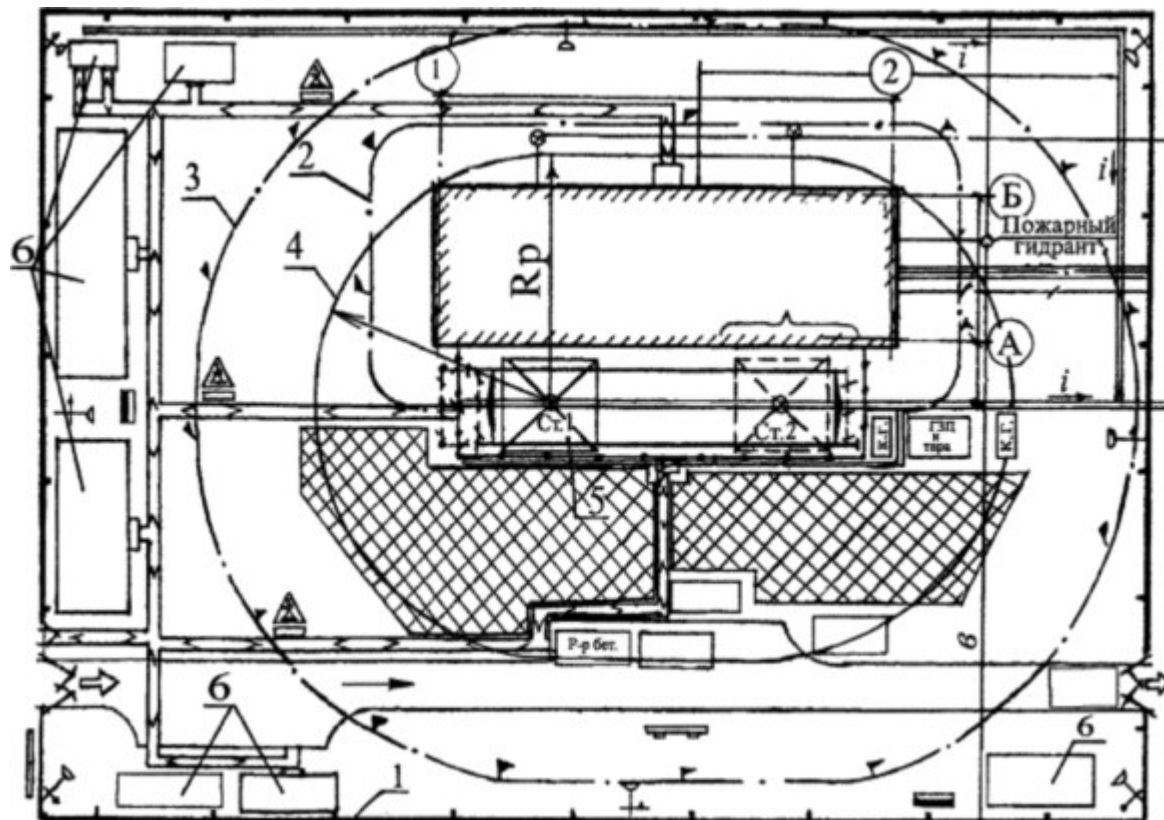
Границы зон при работе башенных кранов. Где 1 - ограждение строительной площадки; 2 - граница опасной зоны вблизи строящегося здания; 3 - граница зоны, опасной для нахождения людей во время перемещения, установки и
